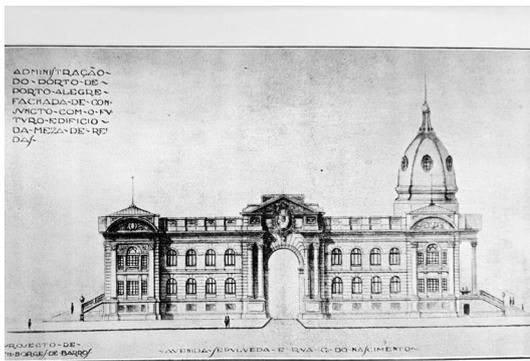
Fachada lateral. Projeto e desenho de Barros.
